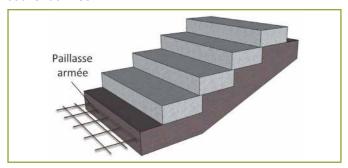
Schéma d'une paillasse armée (Dessin de Cédric Houel)
